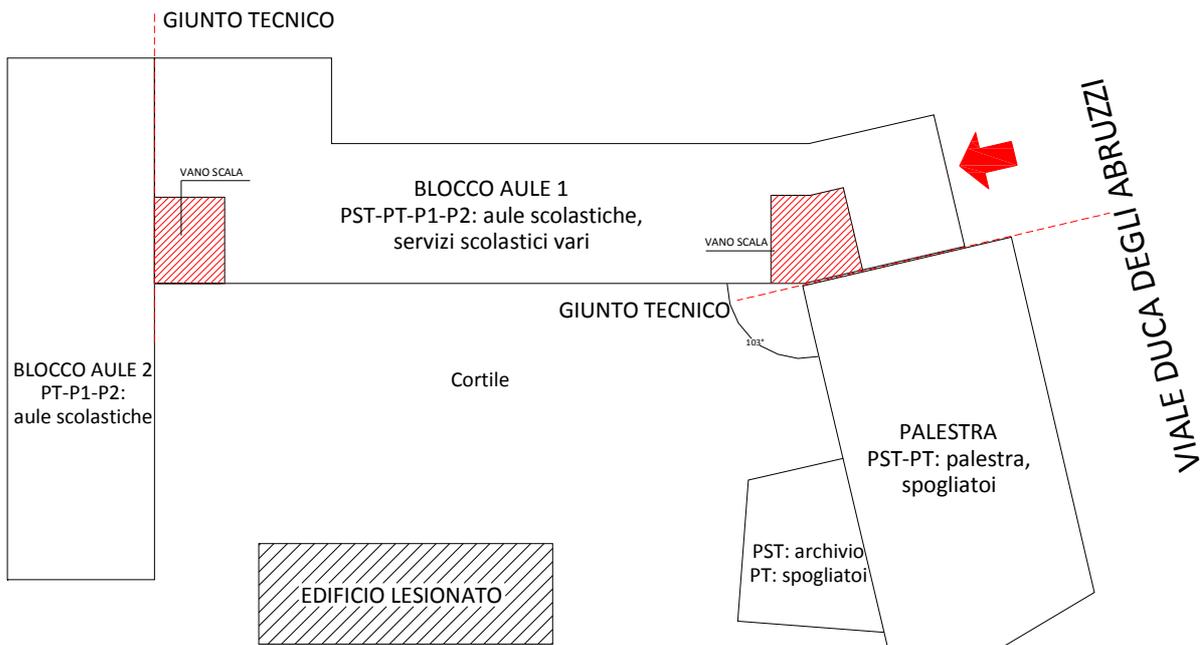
2: Schema planimetrico della disposizione dei vari blocchi del complesso scolastico.
